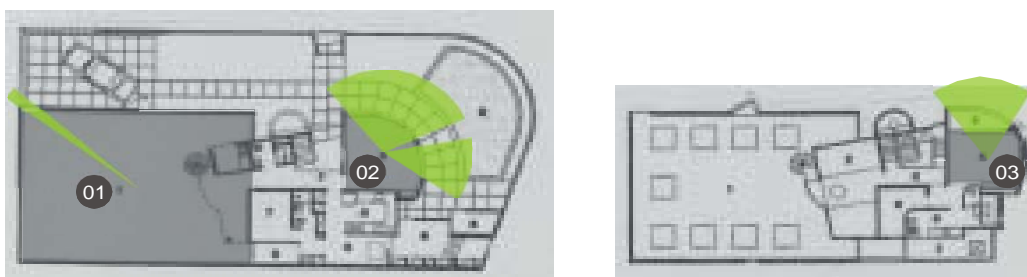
Plantas do Primeiro e do Segundo Piso.
